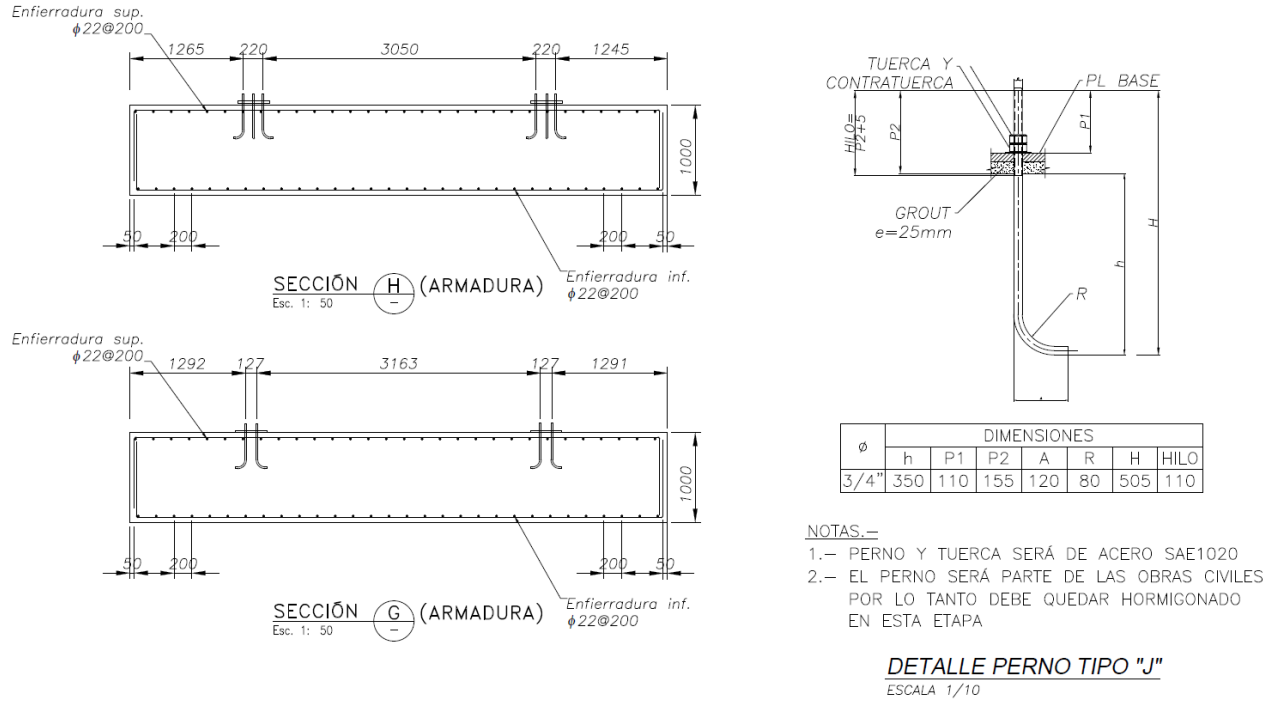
Armadura de refuerzo y detalle perno tipo J
